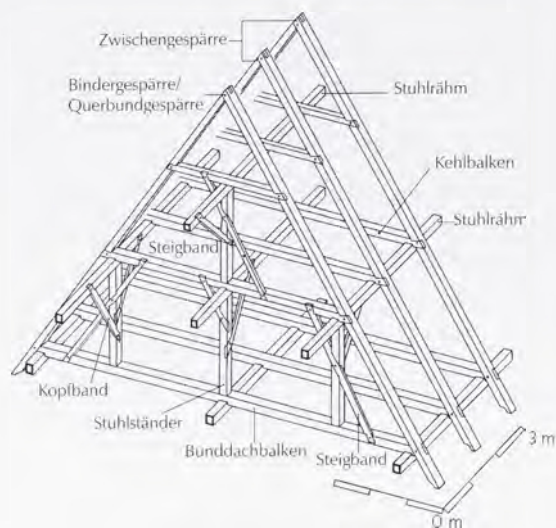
Sparrendach mit quer eingebundenen Sparrenpaaren und verstärkenden Einbauten aus der Kombination von stehendem Quer- und Längsbund (dreifach stehender Stuhl) im 1. Dachgeschoss sowie einfach stehendem Stuhl im 2. Dachgeschoss. In den Zwischengesparren gibt es verstärkende Einbauten in Form von Kehlbalcken. Schwäbisch Hall (Lkr. Schwäbisch Hall), Lange Str. 9, 1394 (d).
